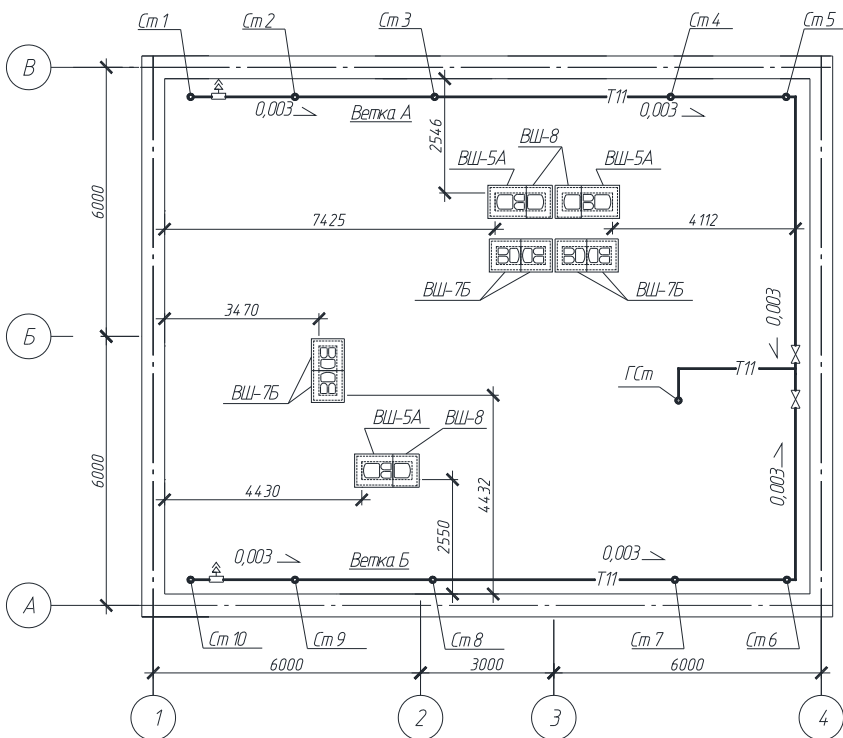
План чердака с приставными унифицированными вентиляционными блоками и верхней разводкой трубопроводов
